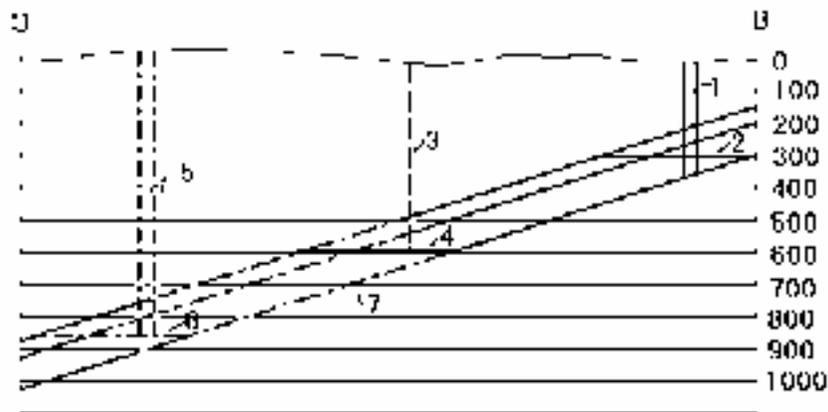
Схема вскрытия при реконструкции. Выработки, проведенные на 1 и 2 этапе реконструкции.
